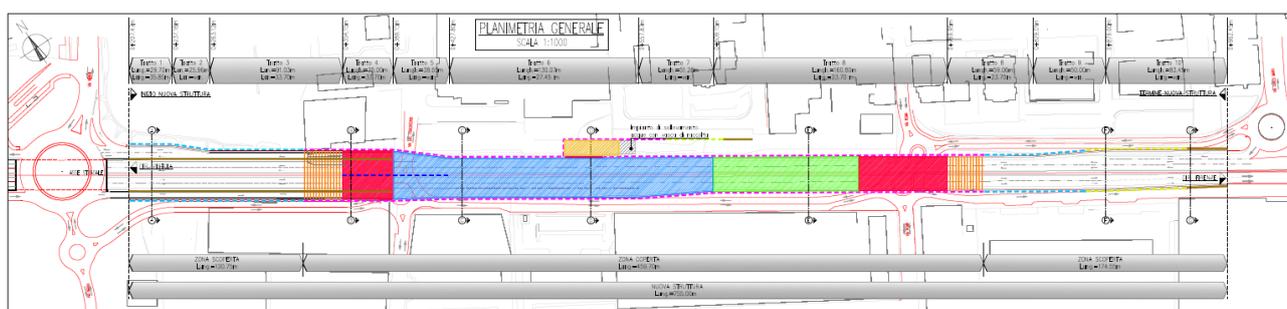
Planimetria di progetto dell'infrastruttura e relative sezioni
